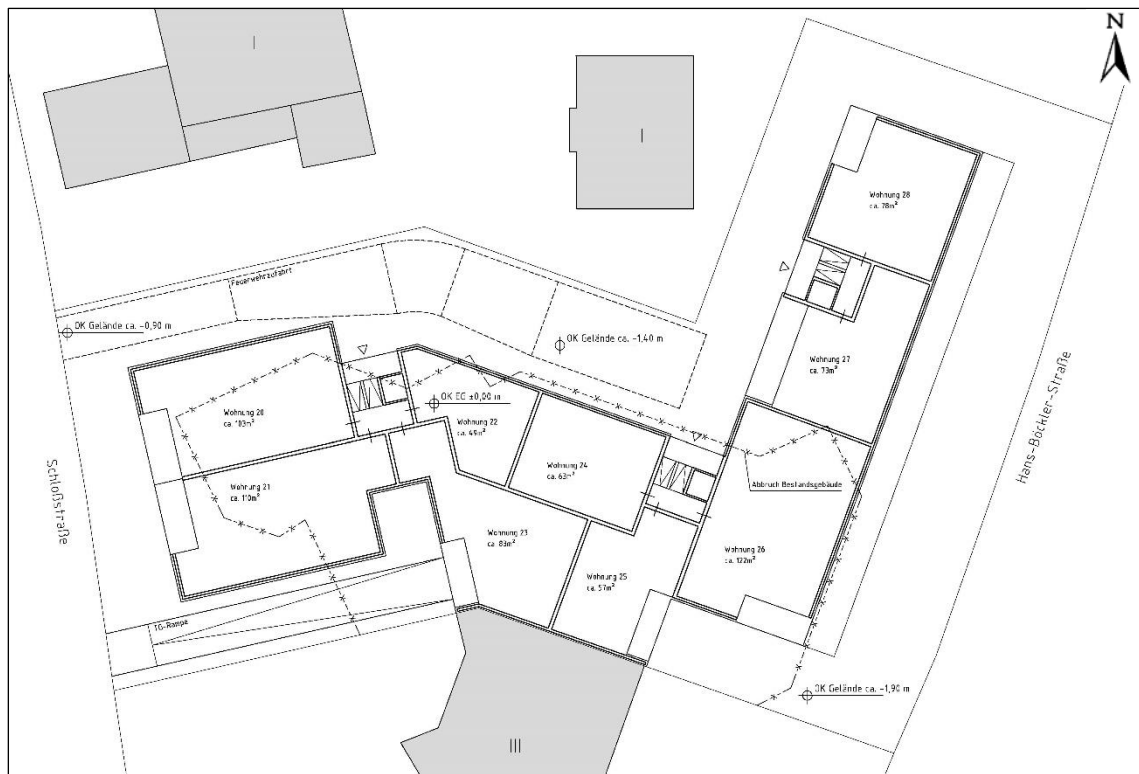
Grundriss des Erdgeschosses des geplanten Mehrfamilienhauses
